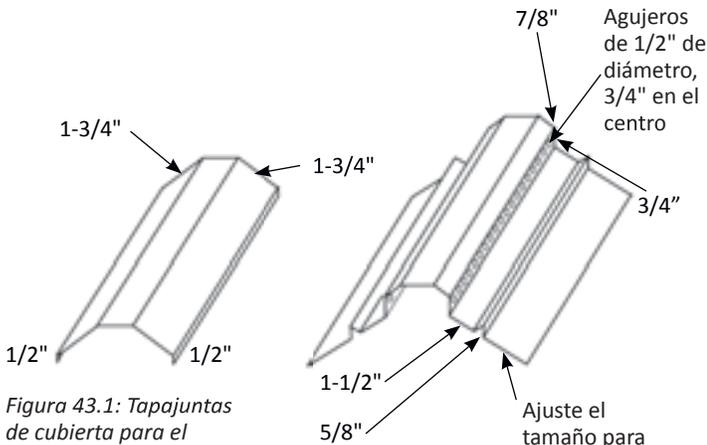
Tapajuntas de cubierta para el sistema de cubierta circular de cumbre ventilada (Circular Cover Vented Ridge Cap Flashing)
